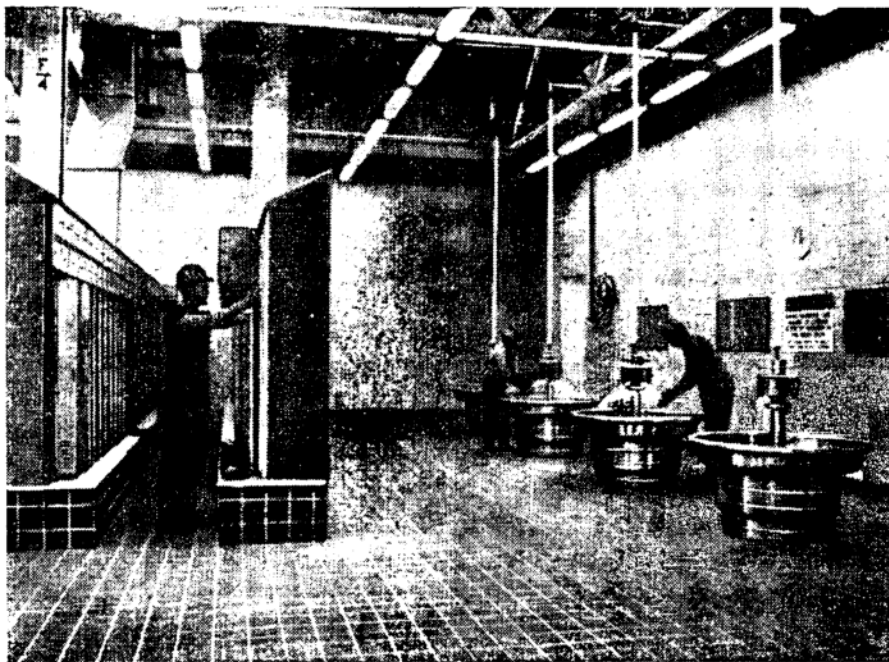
Гардеробное помещение, оборудованное шкафами для спецодежды. К шкафам подведена вытяжная вентиляция
